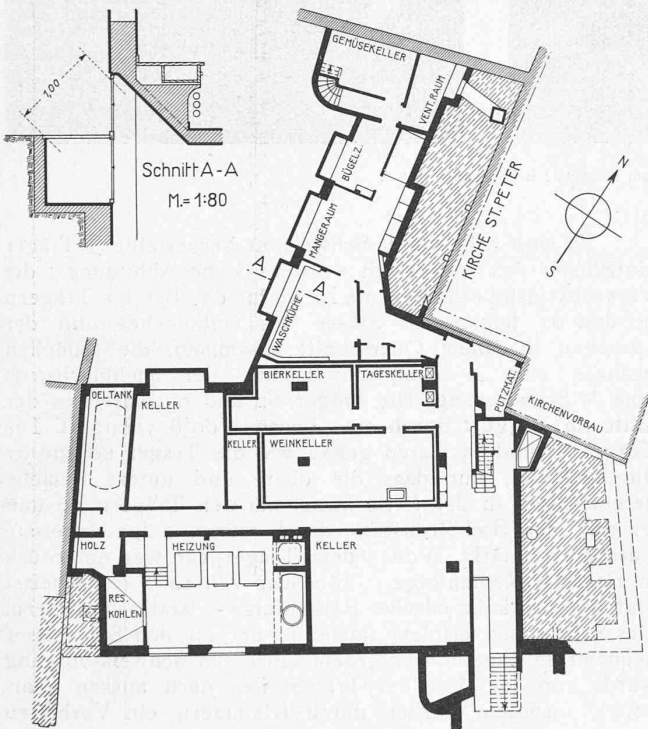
und 5. Grundriss von Keller und Erdgeschoss. — Masstab 1 : 400. Einzelheiten in Vertikalschnitten.
